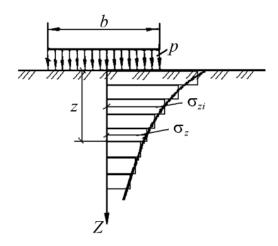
Схема эпюры напряжений по оси штампа (методом послойного суммирования)
